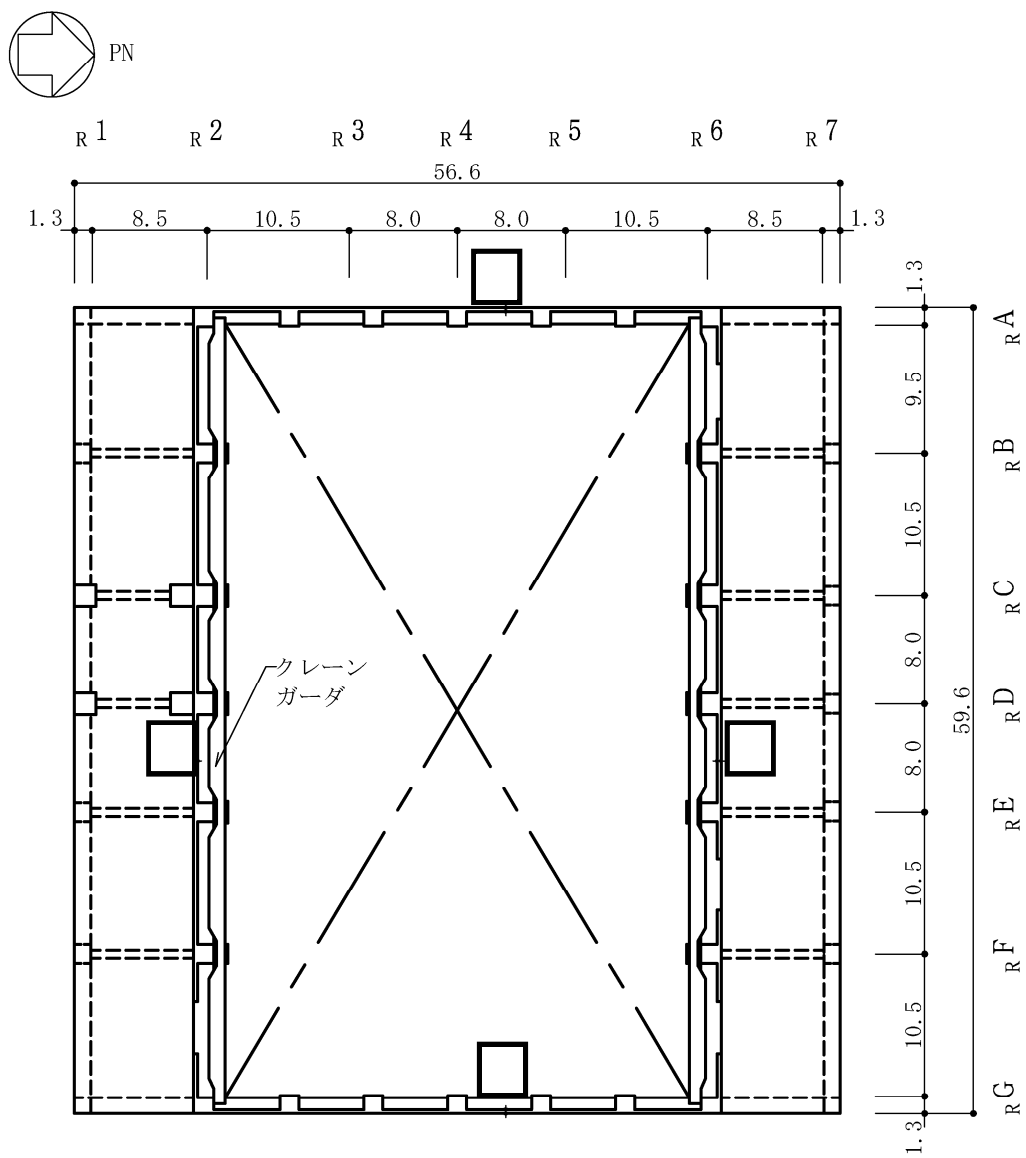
原子炉建屋の概略平面図 (CRF, T.M.S.L. 38.2m) (8/9) (単位 : m)
